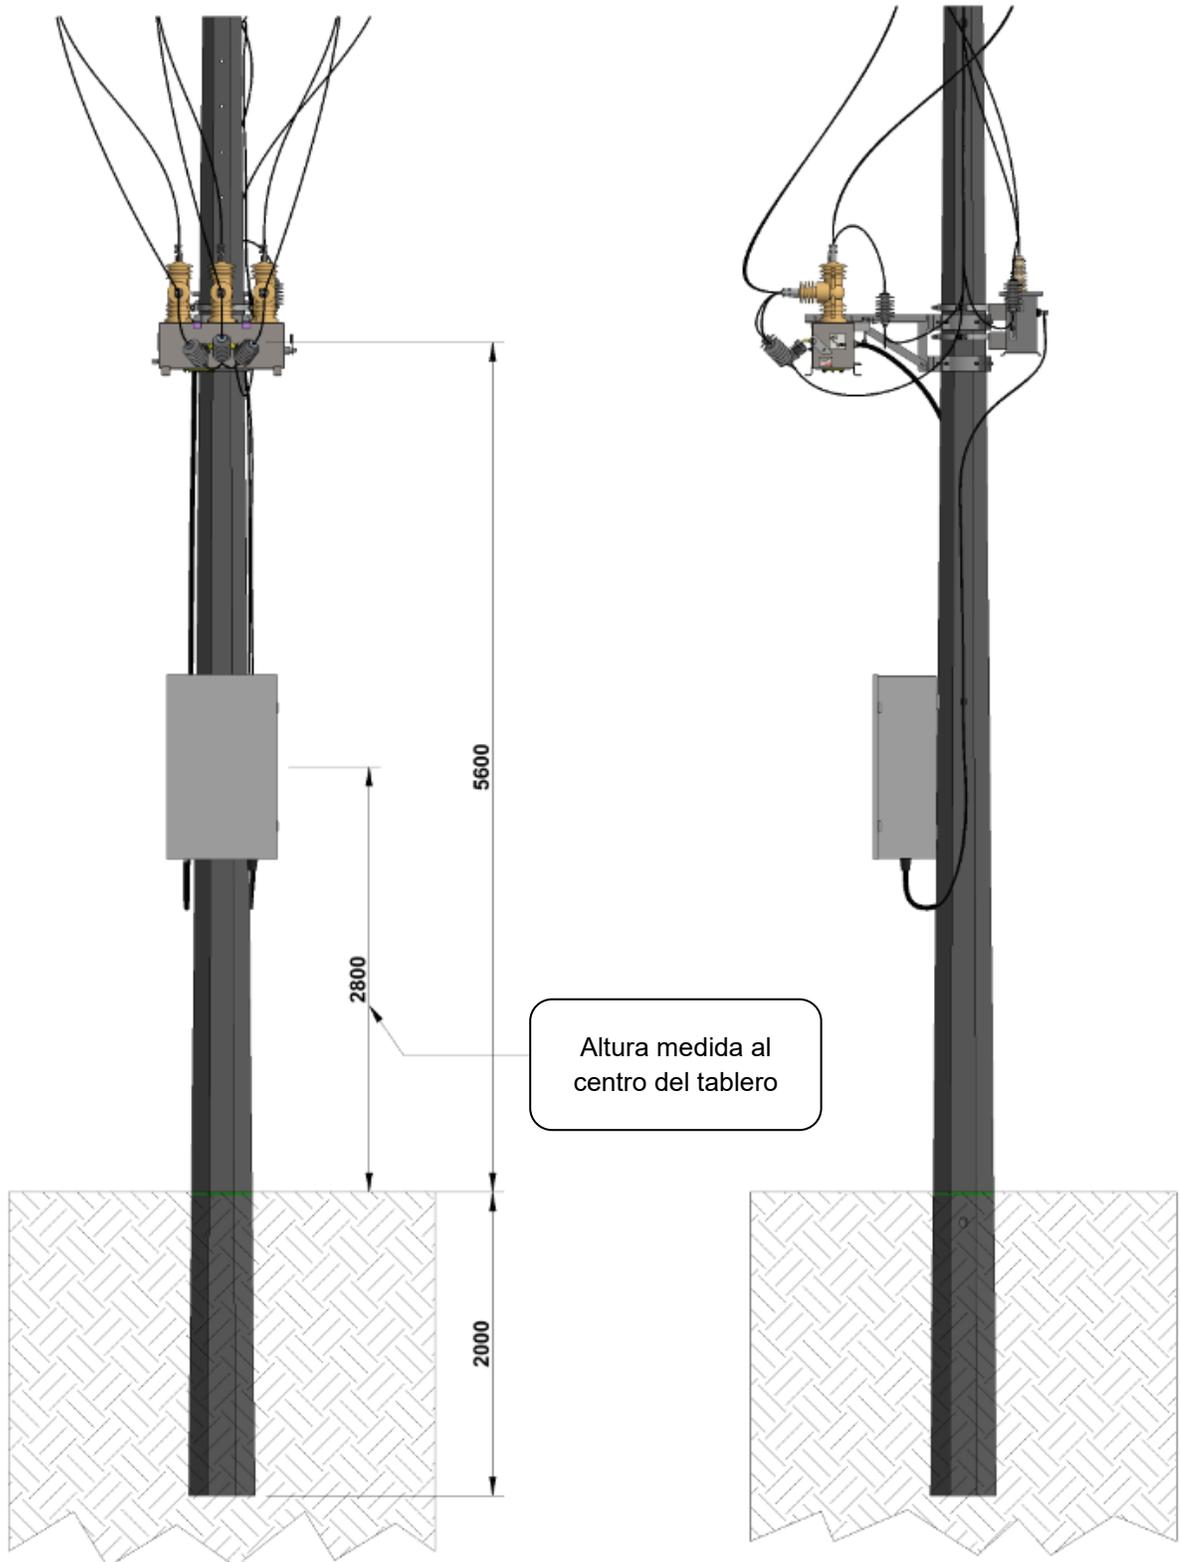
Detalle montaje Bypass y Seccionamiento - Instalación de reconector trifásico en ramal 13.2 kV – Línea Muerta
